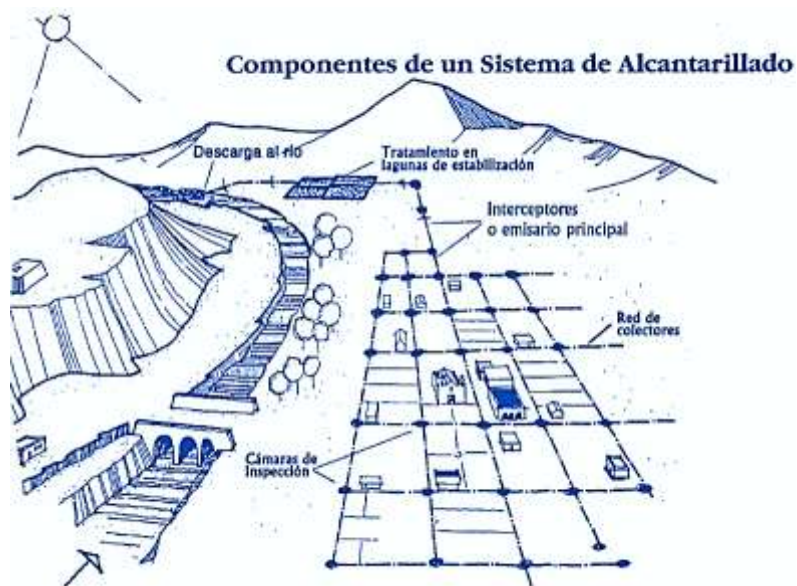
Componentes de un Sistema de Alcantarillado. [27]
